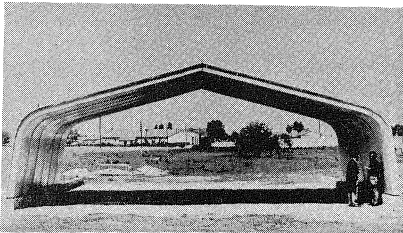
Ein ungarischer Versuch mit wärmedämmten Flächentragwerk-Elementen für den Stallbau aus glasfaserverstärktem Polyester und Polyurethanschaum
